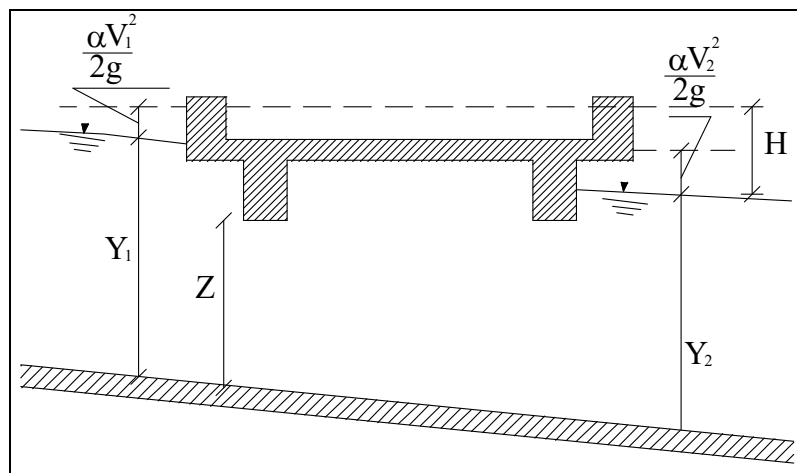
Sezione schematica di un ponte – Schema di calcolo
